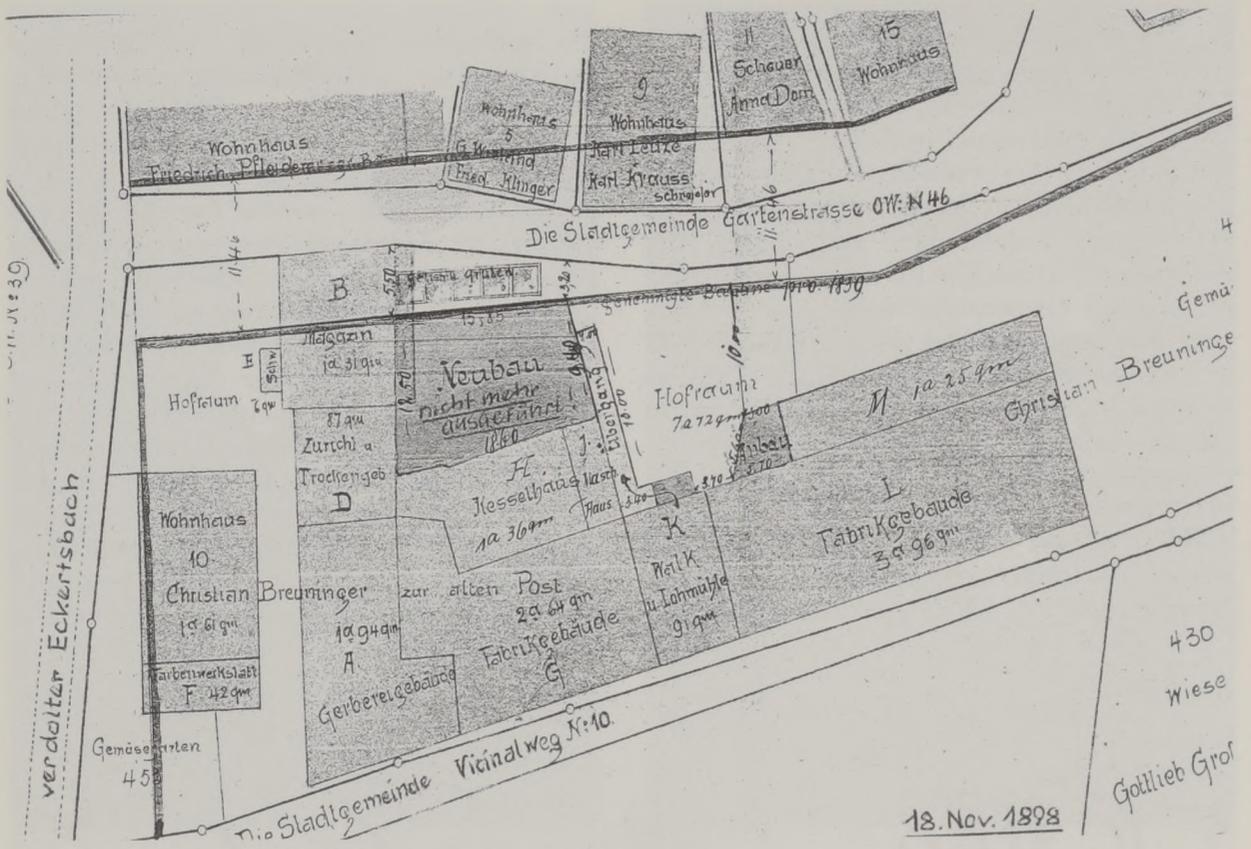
Lageplan der Lederfabrik Christian Breuninger kurz vor dem Verkauf an die Stadt Backnang (Lageplan von 1898).
